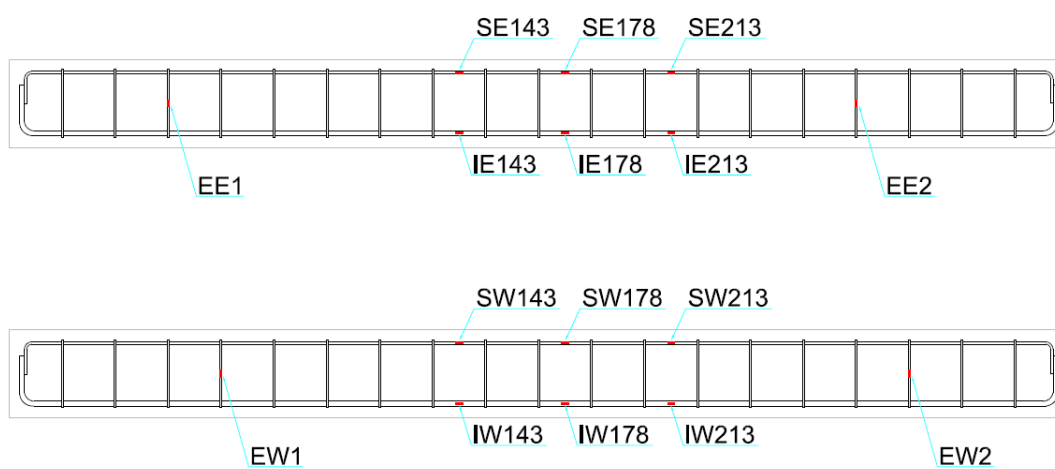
Disposición de las galgas en la armadura para las vigas H65 (*lado Este en la imagen superior y Oeste en la inferior*). Fase Vigas I
